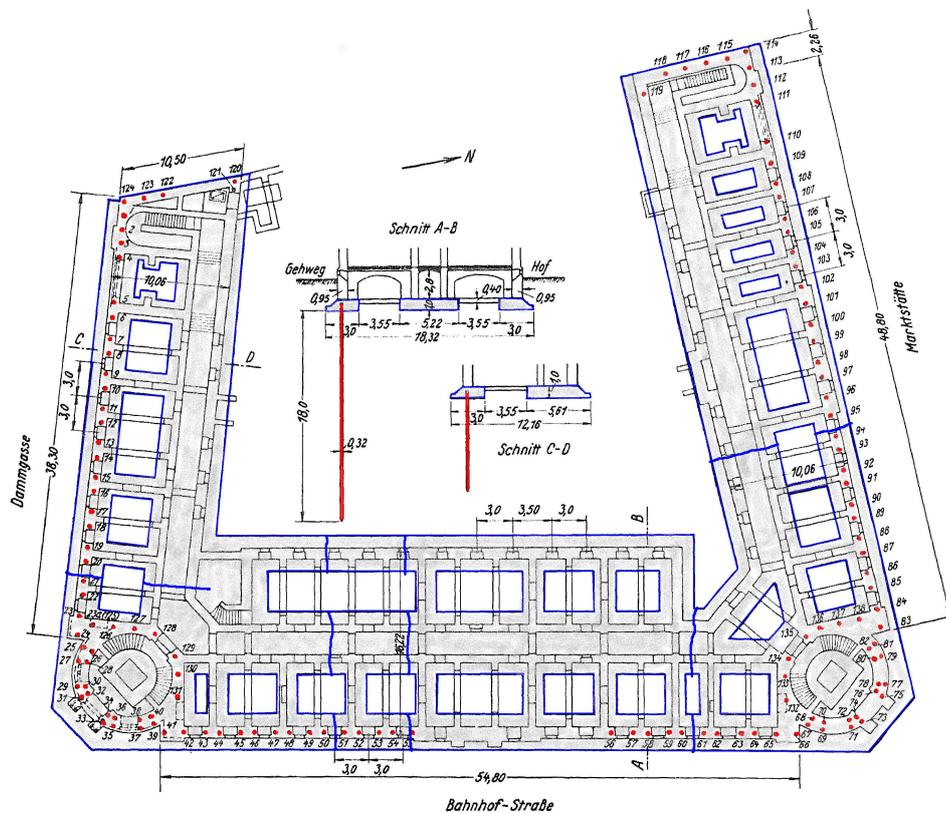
Gebäudegrundriss mit Anordnung der Presssegmentpfähle [21]
